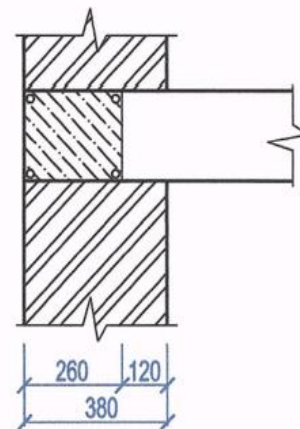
Схемы к оценке работы кирпичных стен здания
